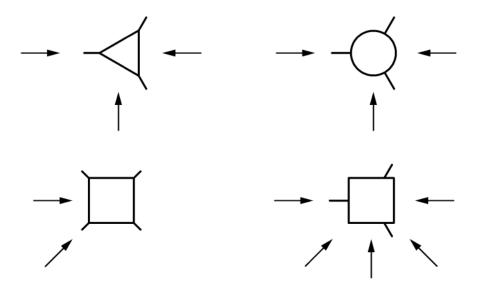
Typische zu berücksichtigende Windrichtungen
